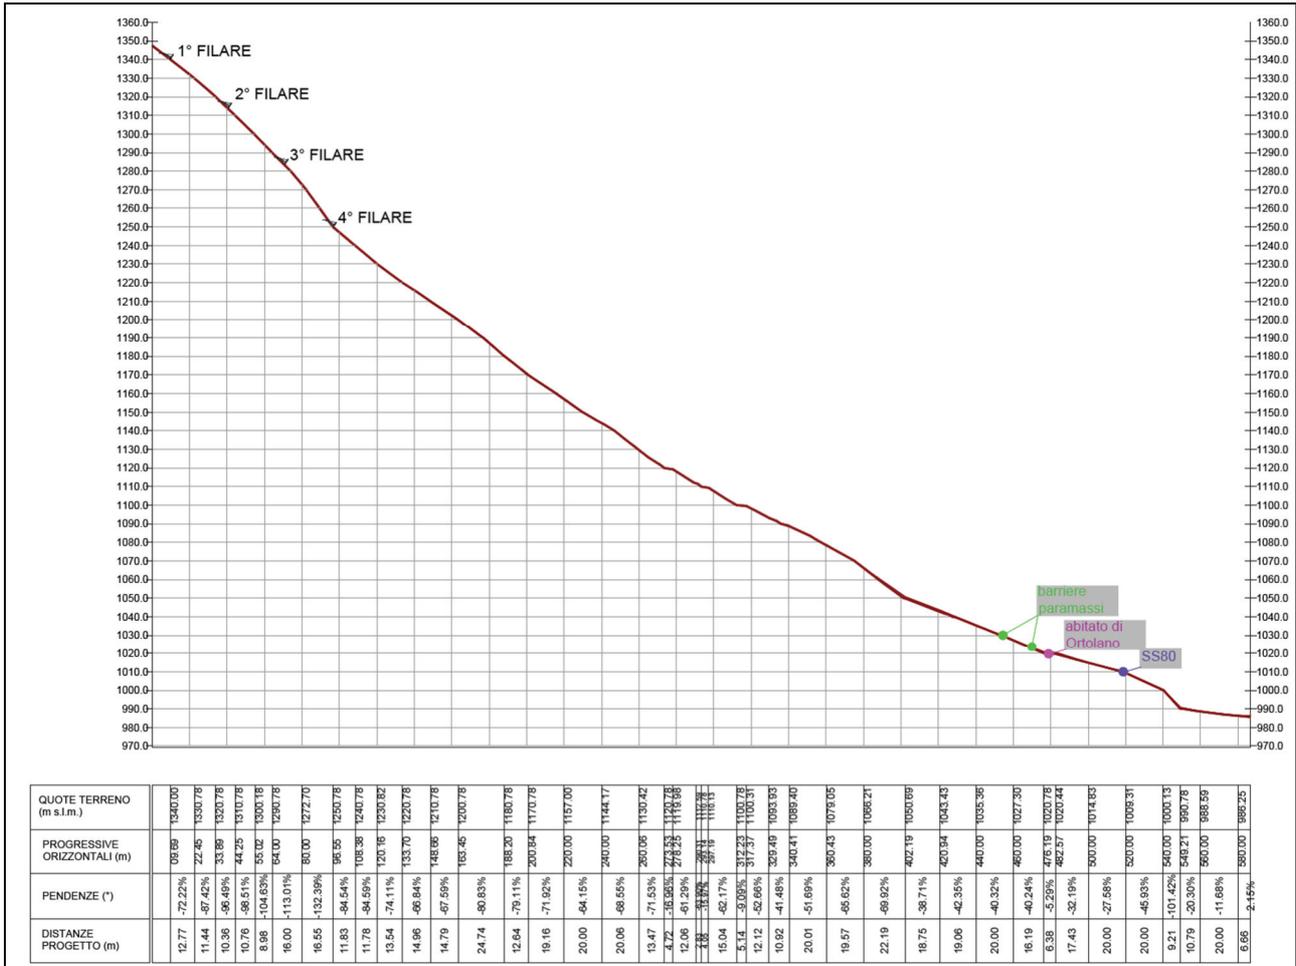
Profilo longitudinale valanga 1 – area di distacco A (Elaborato B12)
